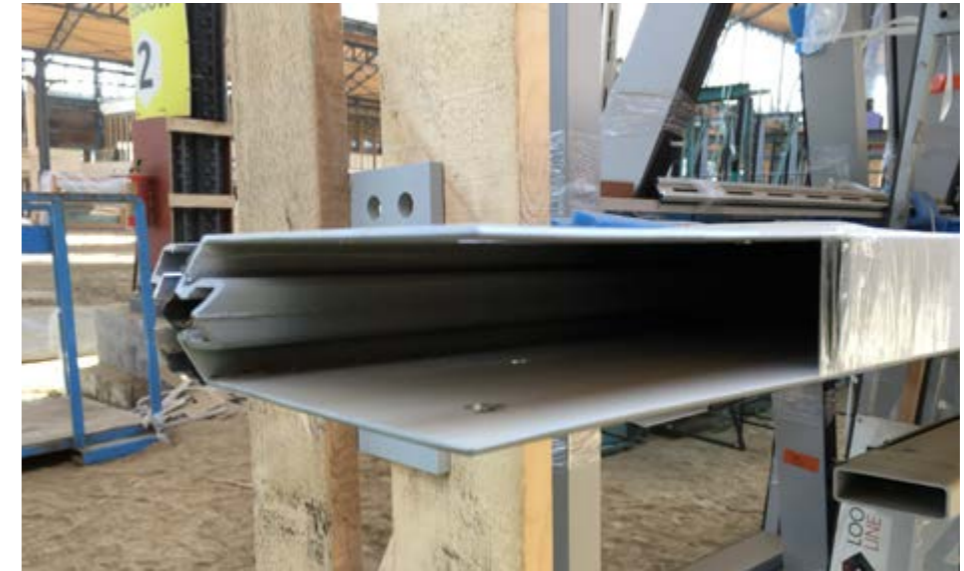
Détail du faitage de la façade intérieure, un élément préfabriqué. (Source : Jansen AG)
